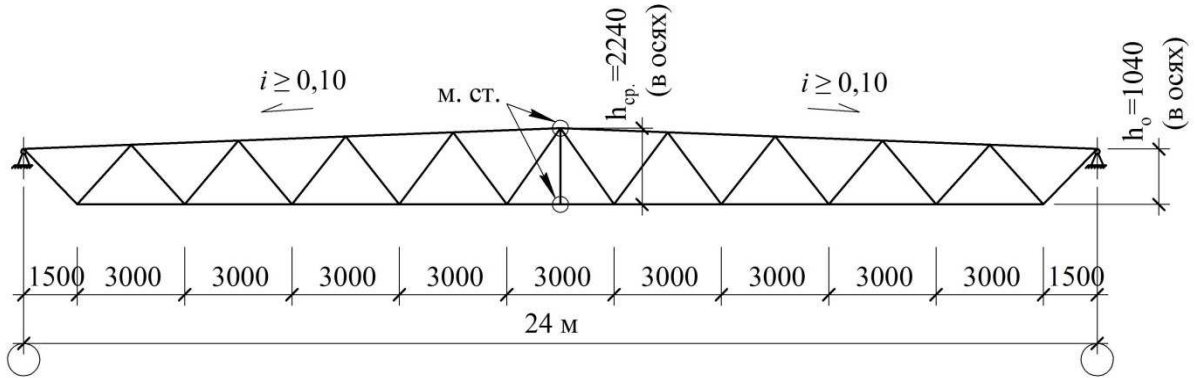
, а – Конструктивная схема стропильных ферм из гнутых профилей с опущенным нижним поясом из гнутых замкнутых профилей пролетом 24 м
